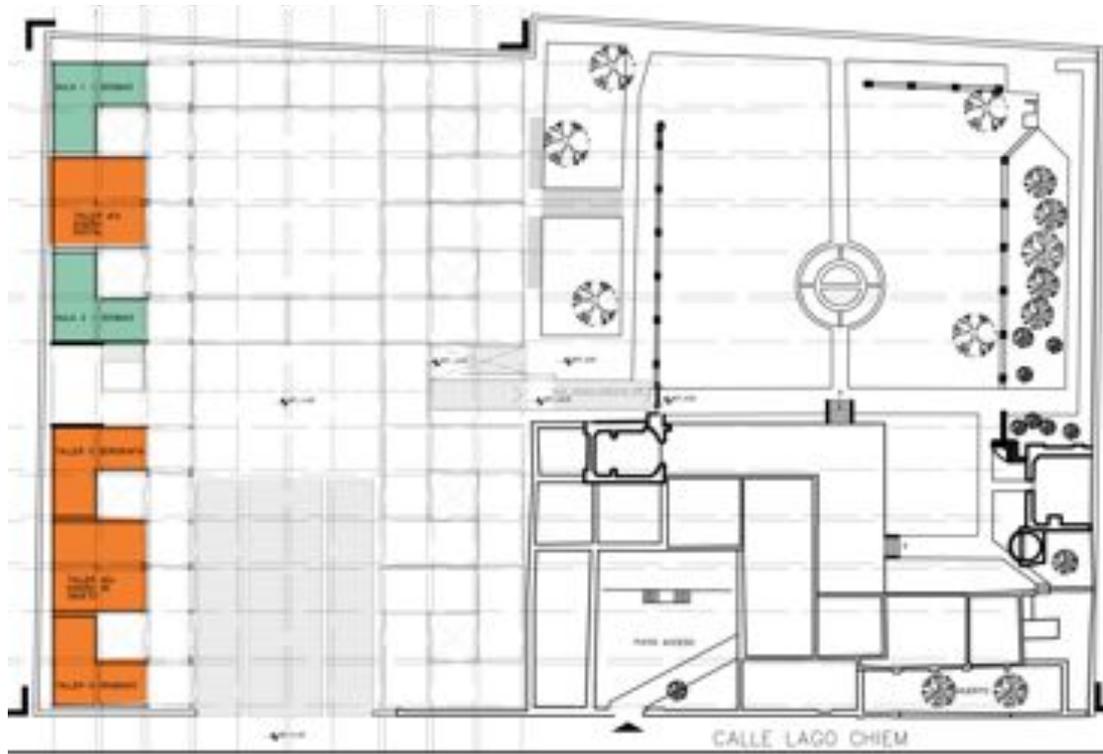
Zonificación en planta baja y planta alta. Confrontar colores con el programa arquitectónico.
